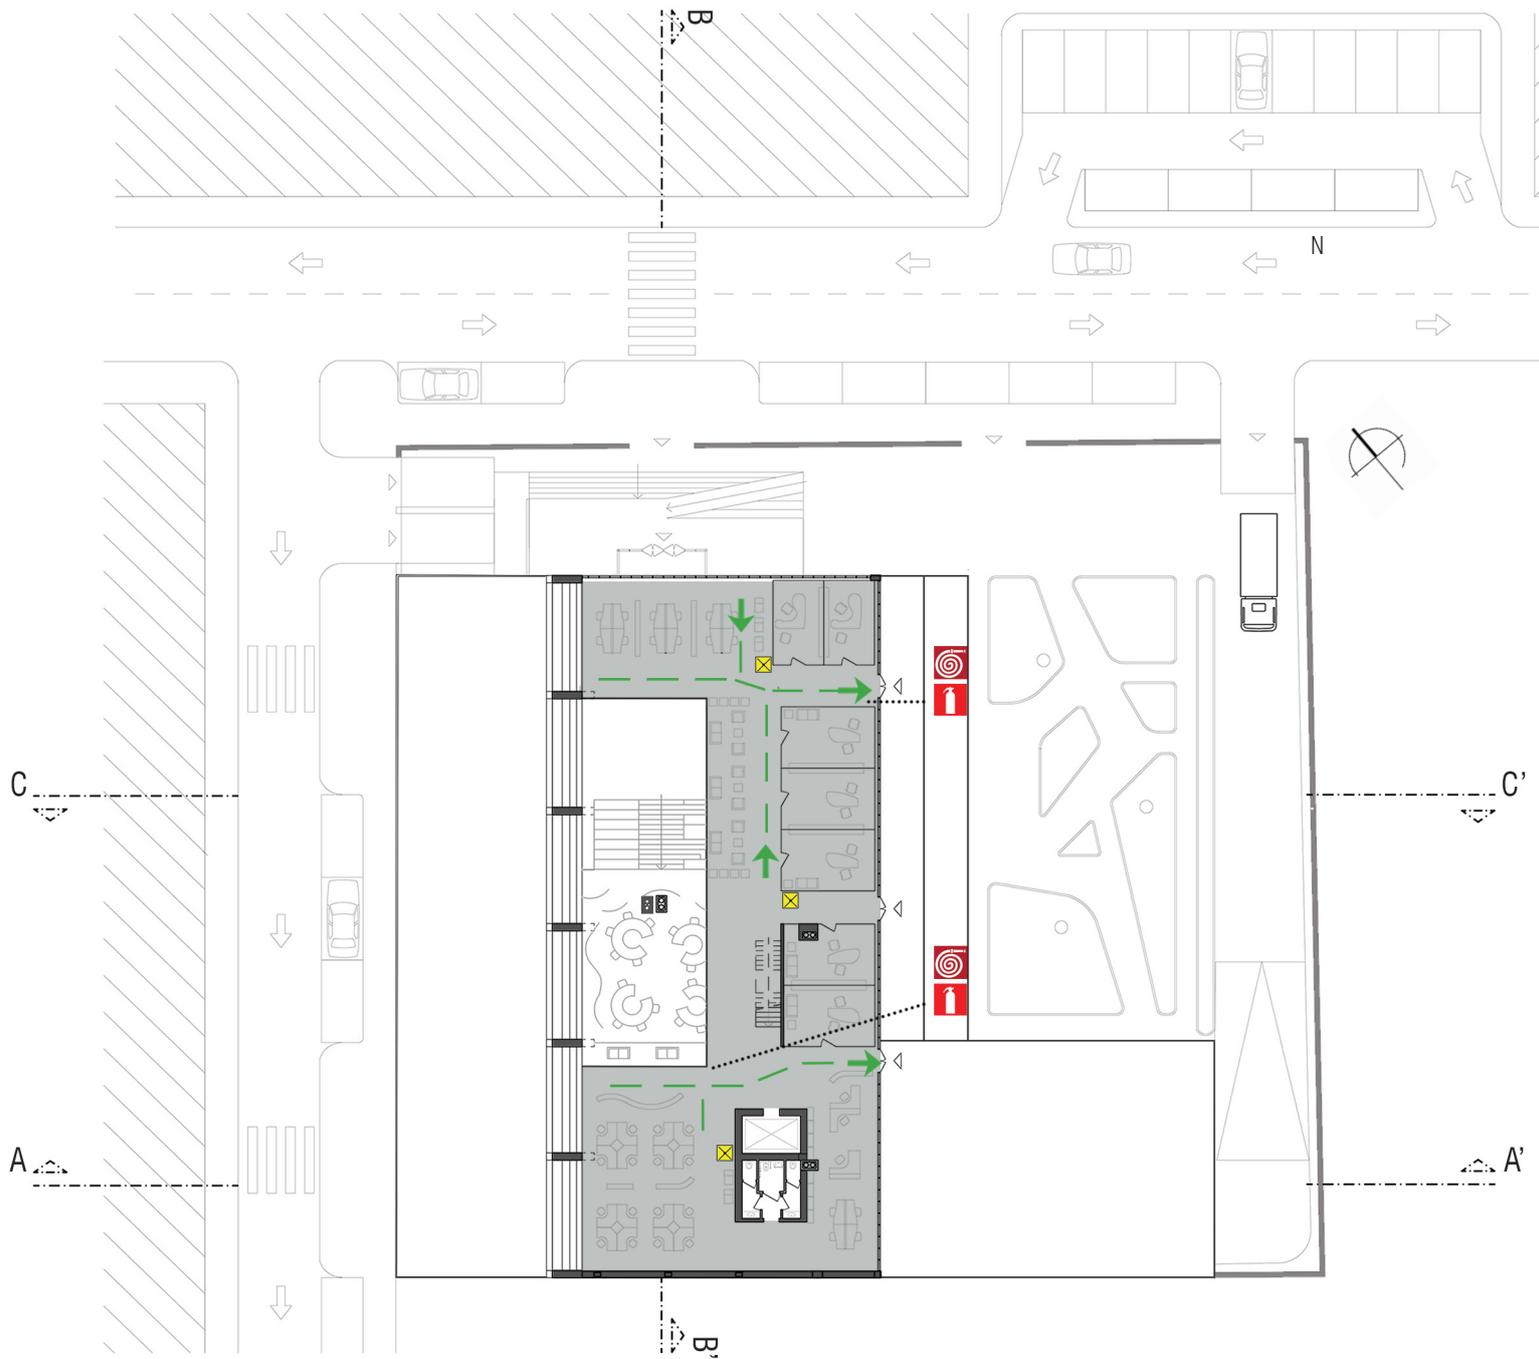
Planimetria sicurezza interna - piano terra. Prodotto: Drazza - Martina
